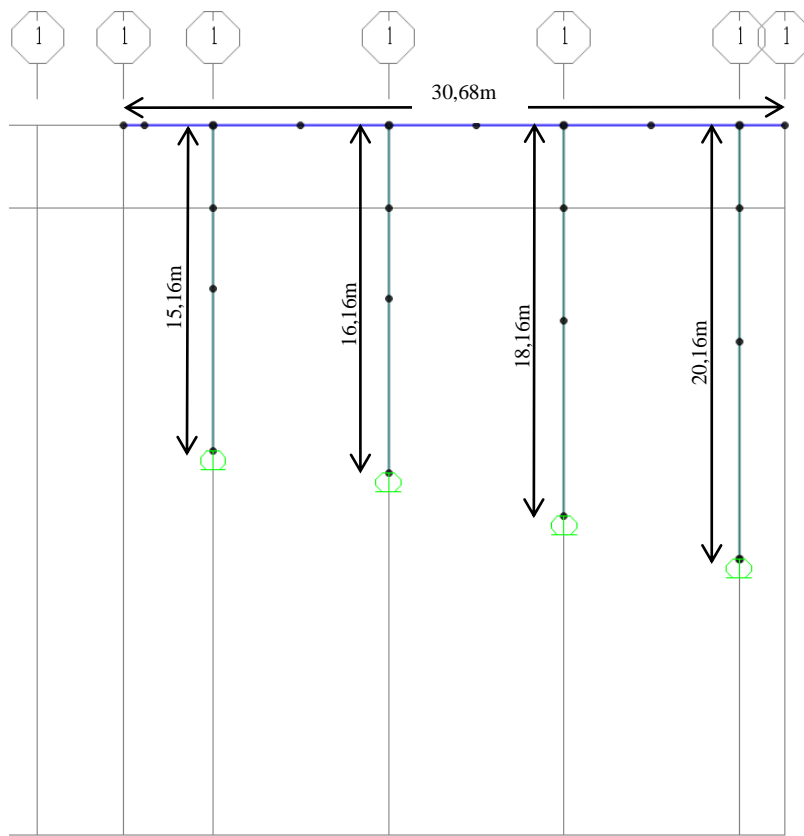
Vista en elevación del plano 1 de geometría, paralelo a plano Y-Vertical'.
